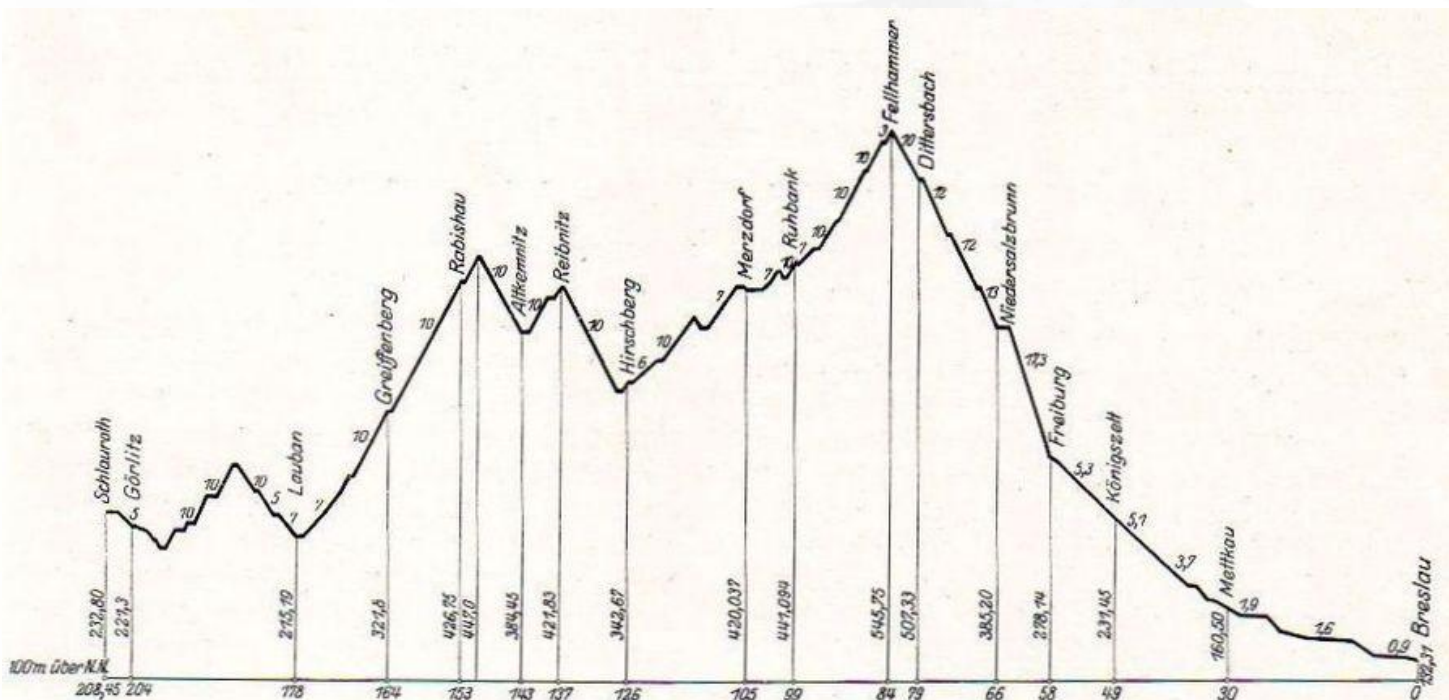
Höhenplan der Strecke Breslau-Görlitz (Schlauroth).
